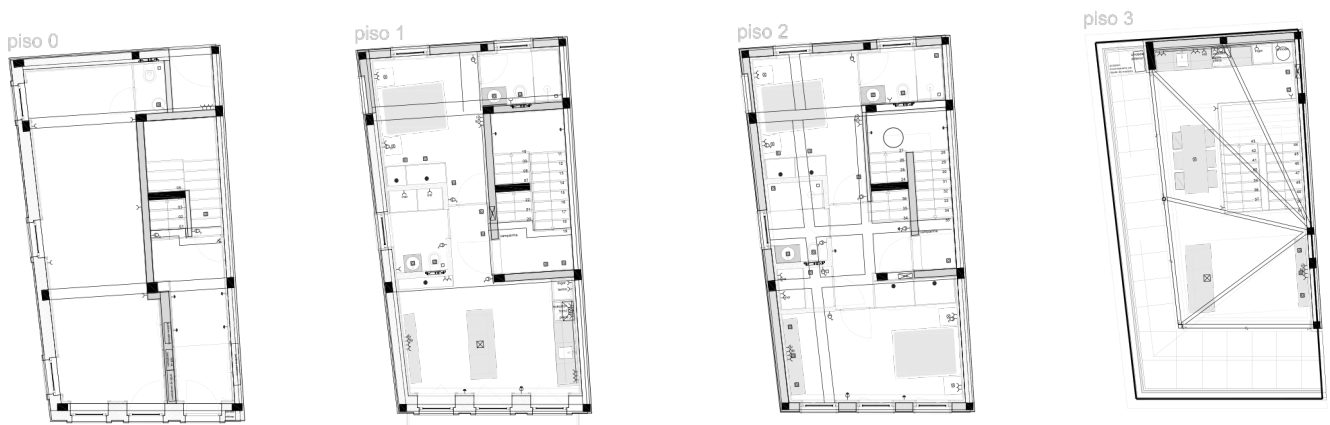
Plantas de Proposta do gabinete de Arquitetura
